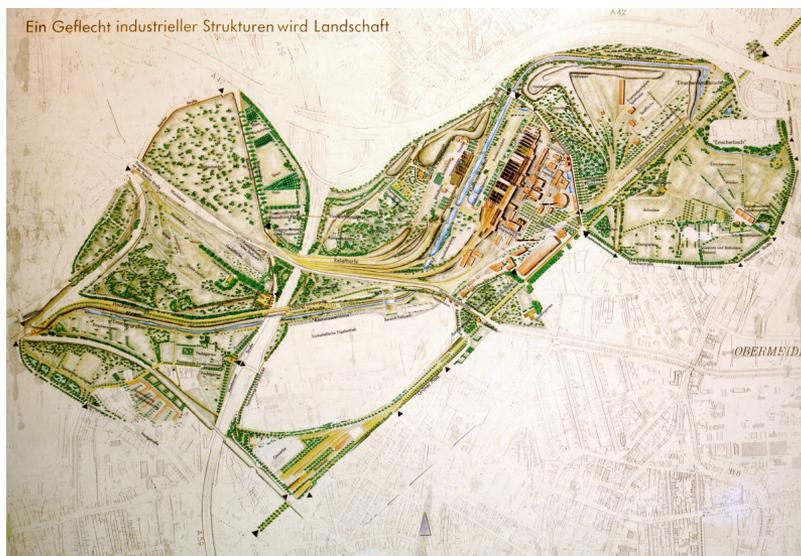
Parque Norte, Duisburg, 1990-2002: planta general.
